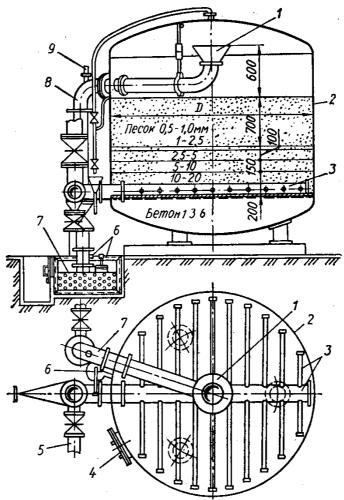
Схема вертикального напорного фильтра: 1 — воронка; 2 — корпус; 3 — дренажная система; 4 — люк; 5 — трубы для отвода фильтрата; 6 — поплавок; 7 — лоток для промывной воды; 8 — трубопровод; 9 — предохранительный клапан
